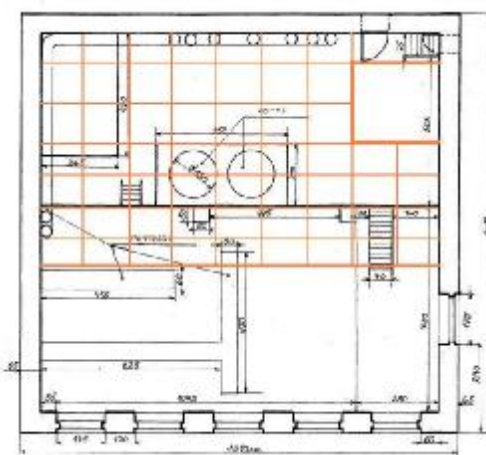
Půdorys části areálu – hlavní budovy s kotelnou
